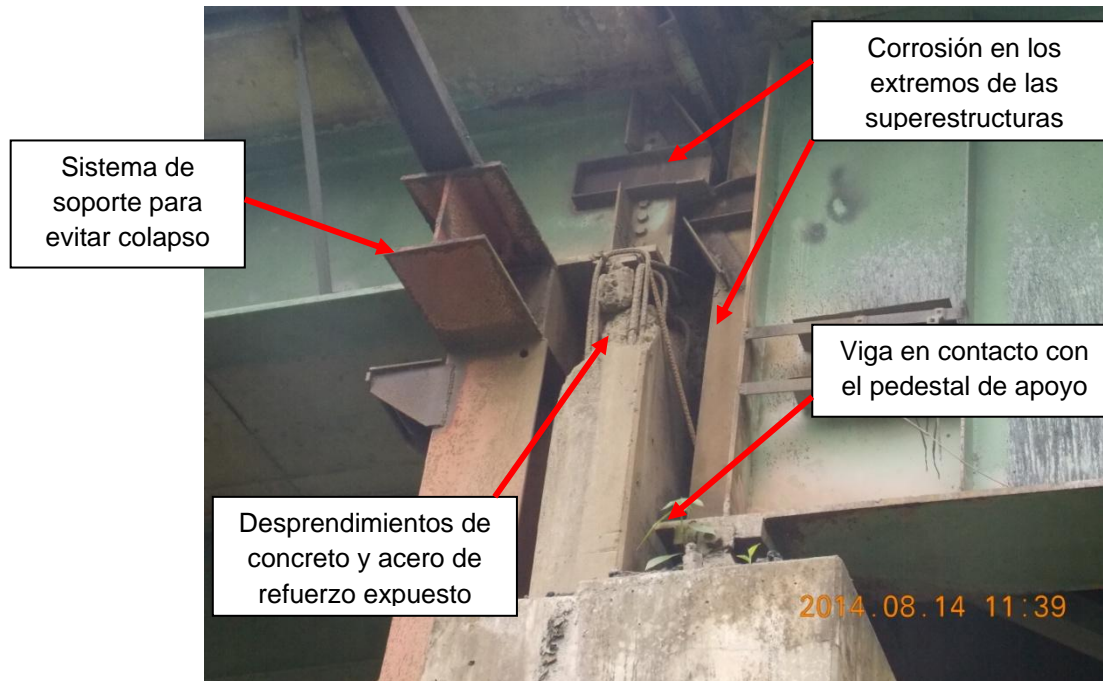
Vista del pedestal de apoyo de la superestructura 2 sobre la pila 7.
